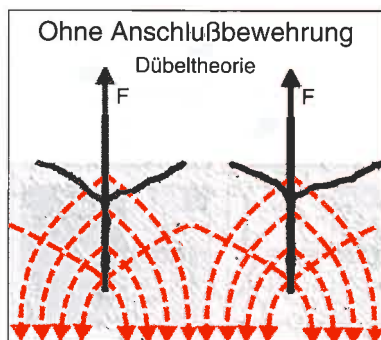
Eingemörtelte Bewehrungsstäbe ohne Anschlussbewehrung
